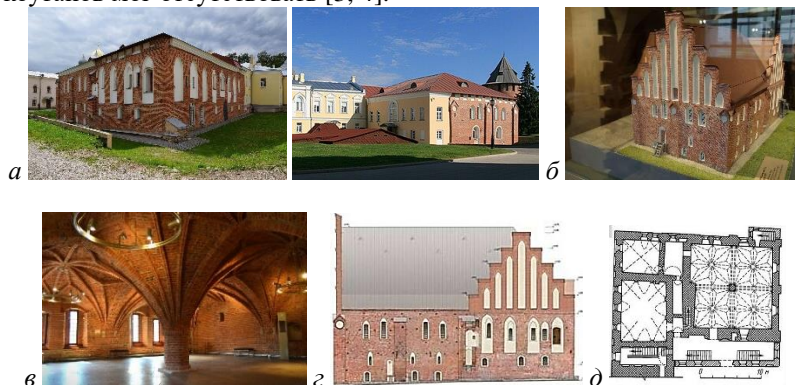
Владичья палата Новгородского кремля: а – внешний вид; б – макет; в – интерьер; з – реконструкция фасада; д – схема плана
